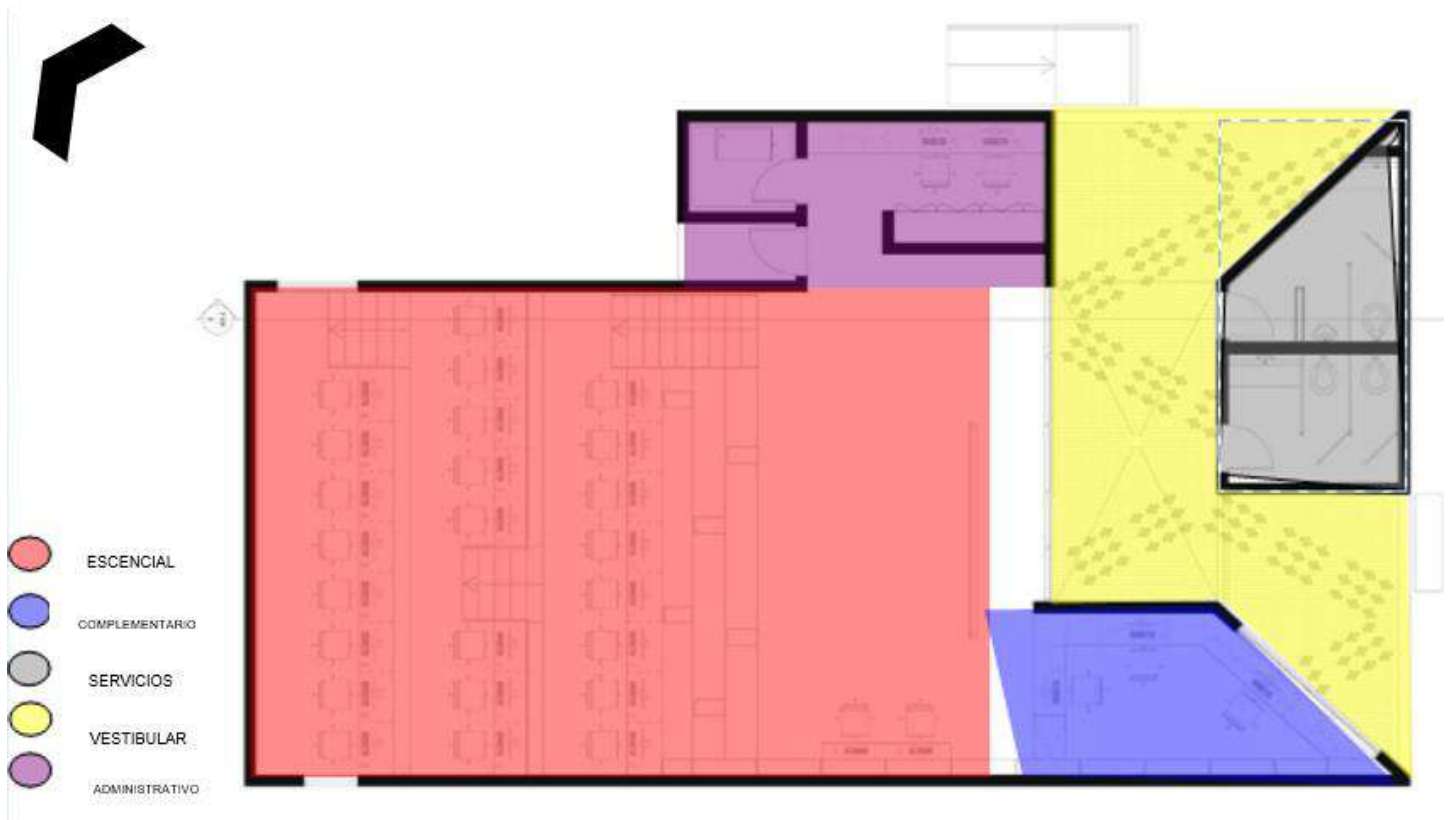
Planta arquitectónica Biblioteca Casa de las Ideas
